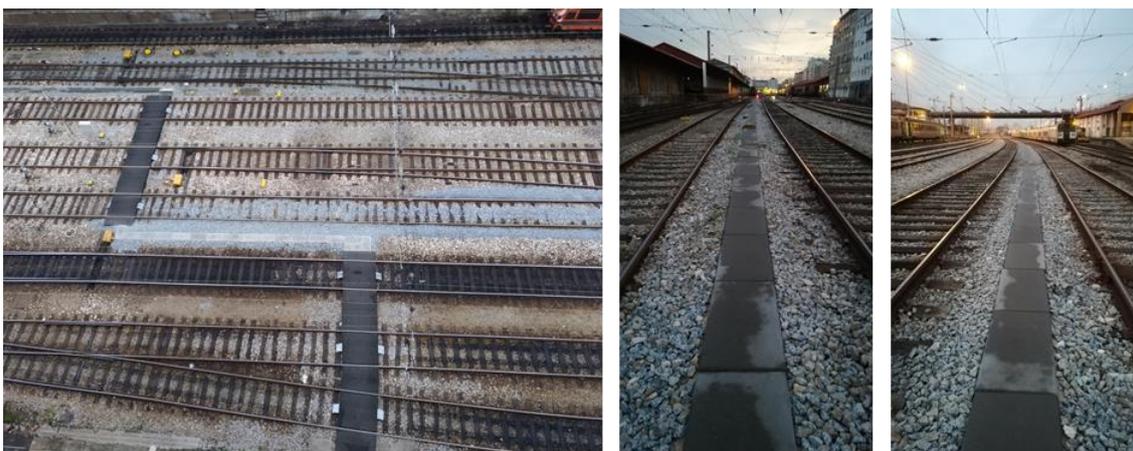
Beneficiação e união de atravessamentos existentes (à esq.) e novos estrados longitudinais com lajetas de betão (à dta.)
